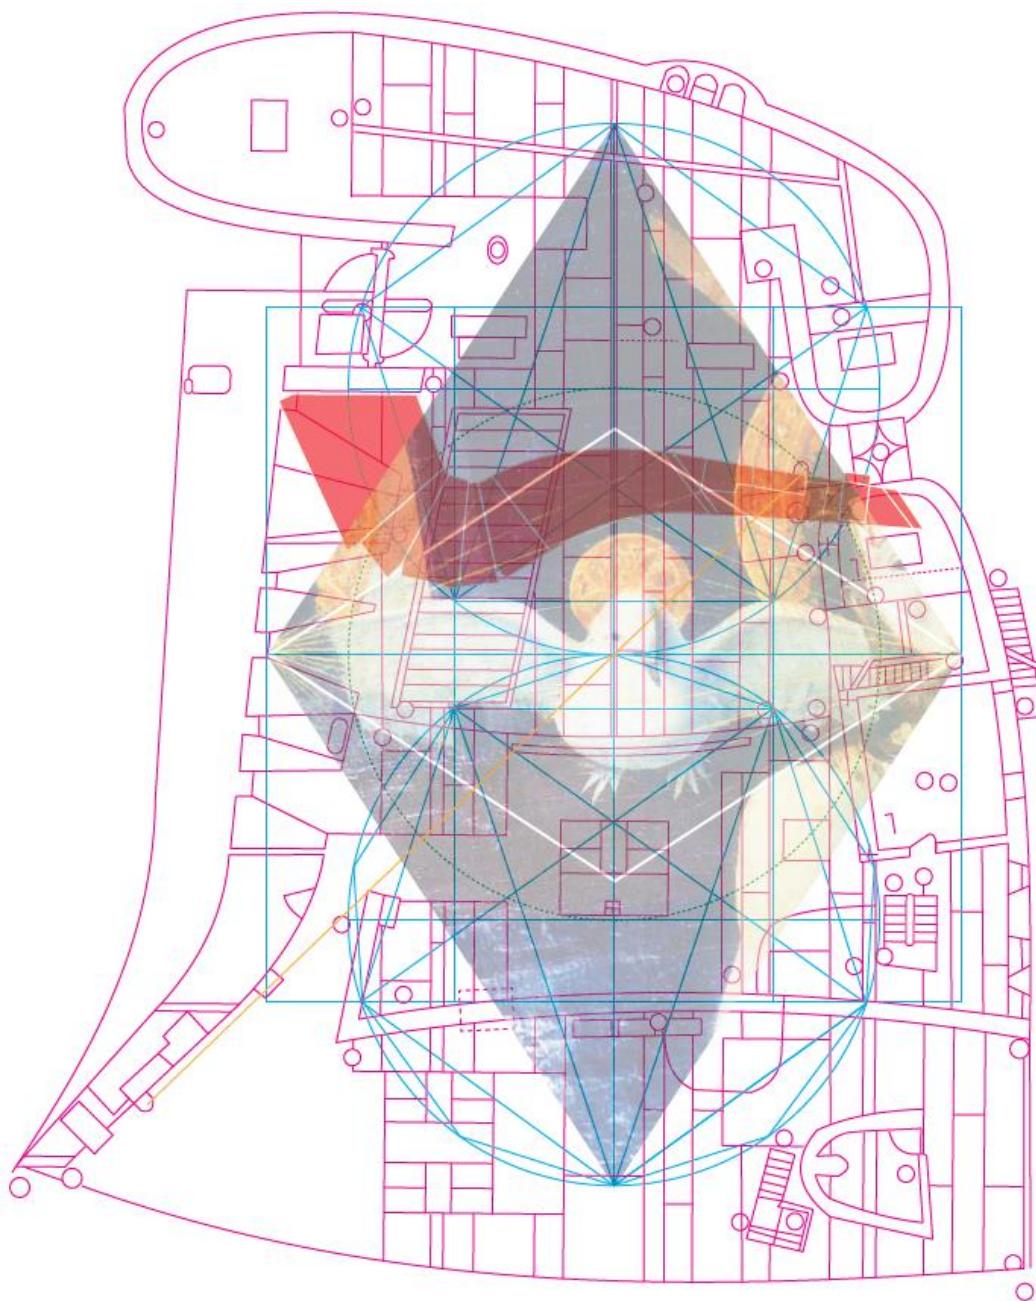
Planimetria con muro sud virtuale e bisettrice dello spazio di Ronchamp, con tracciato regolatore e losanga in verticale contenente quella orizzontale.
